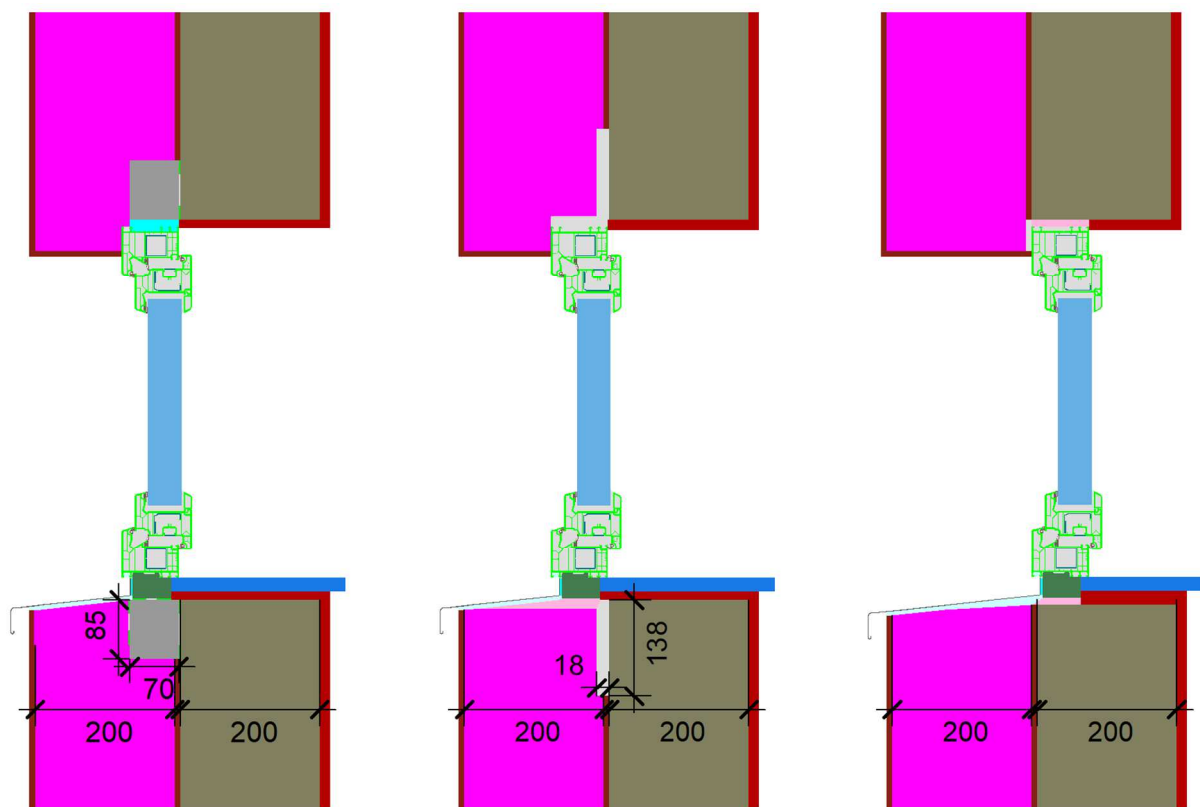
2D-Modelle der Einbausituationen. Links mit blaugelb Triotherm+. Mitte für den Einbau mit Stahlwinkeln. Rechts bündig mit der Wand.
